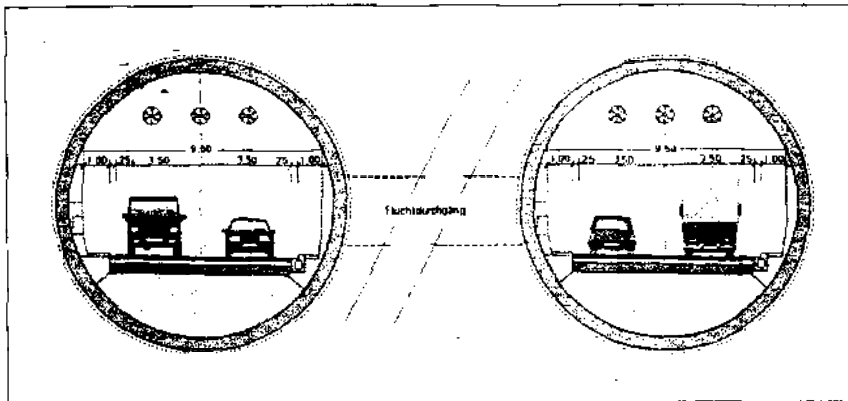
Querschnitt der Tunnellösung, 2-Röhren-Tunnel RQ 26 t
